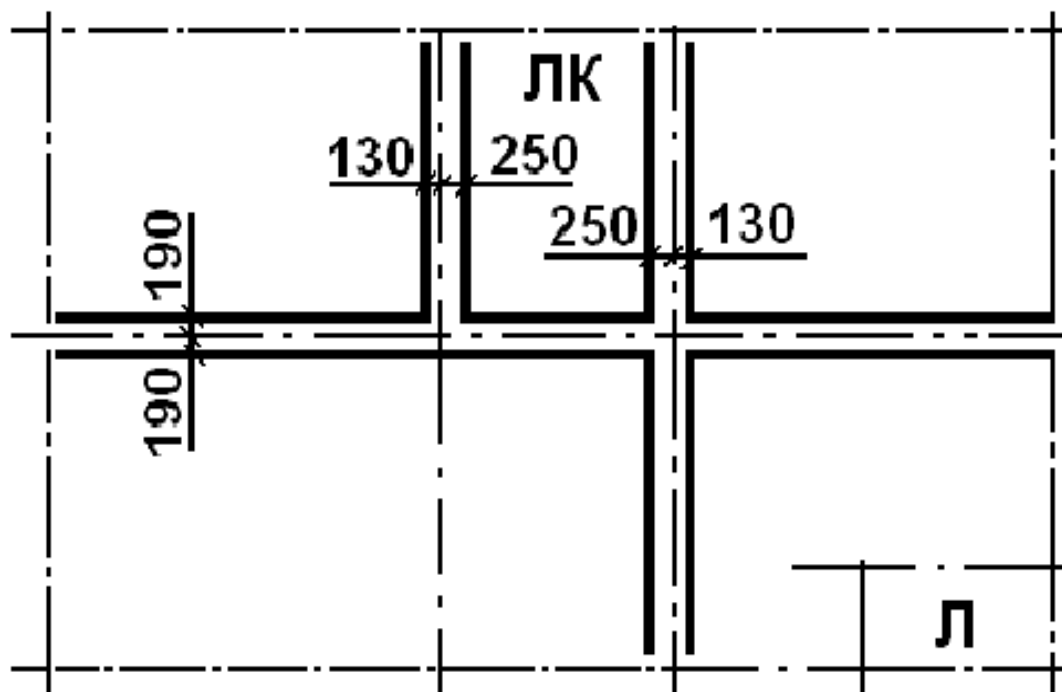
Привязка внутренних стен и стен лестничных клеток
